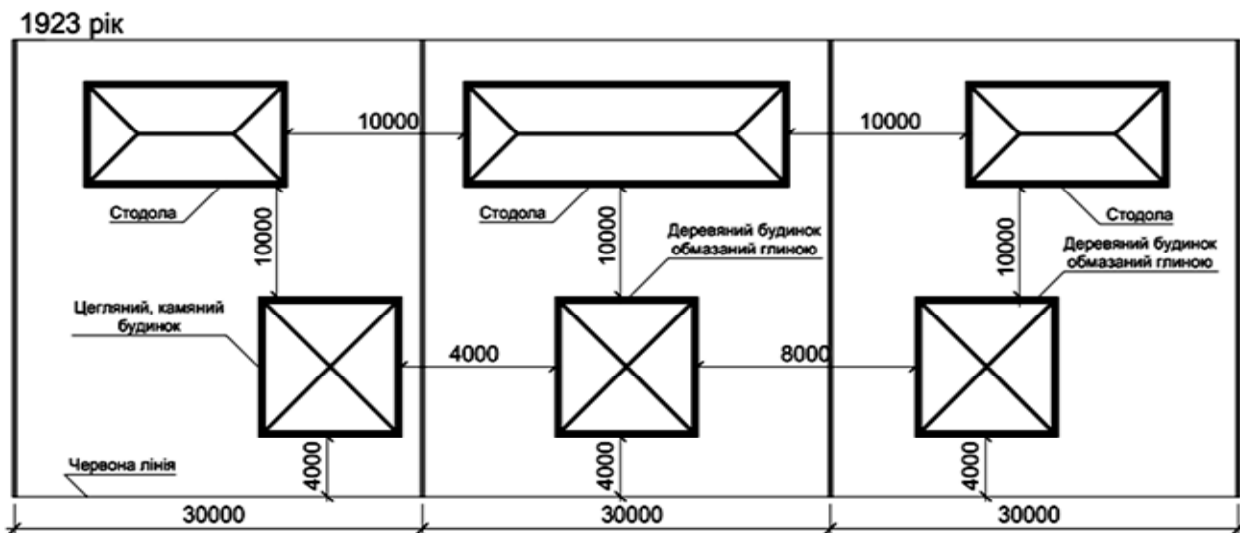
Схеми розпланування садибної забудови в Україні з урахуванням норм 1923 р.
